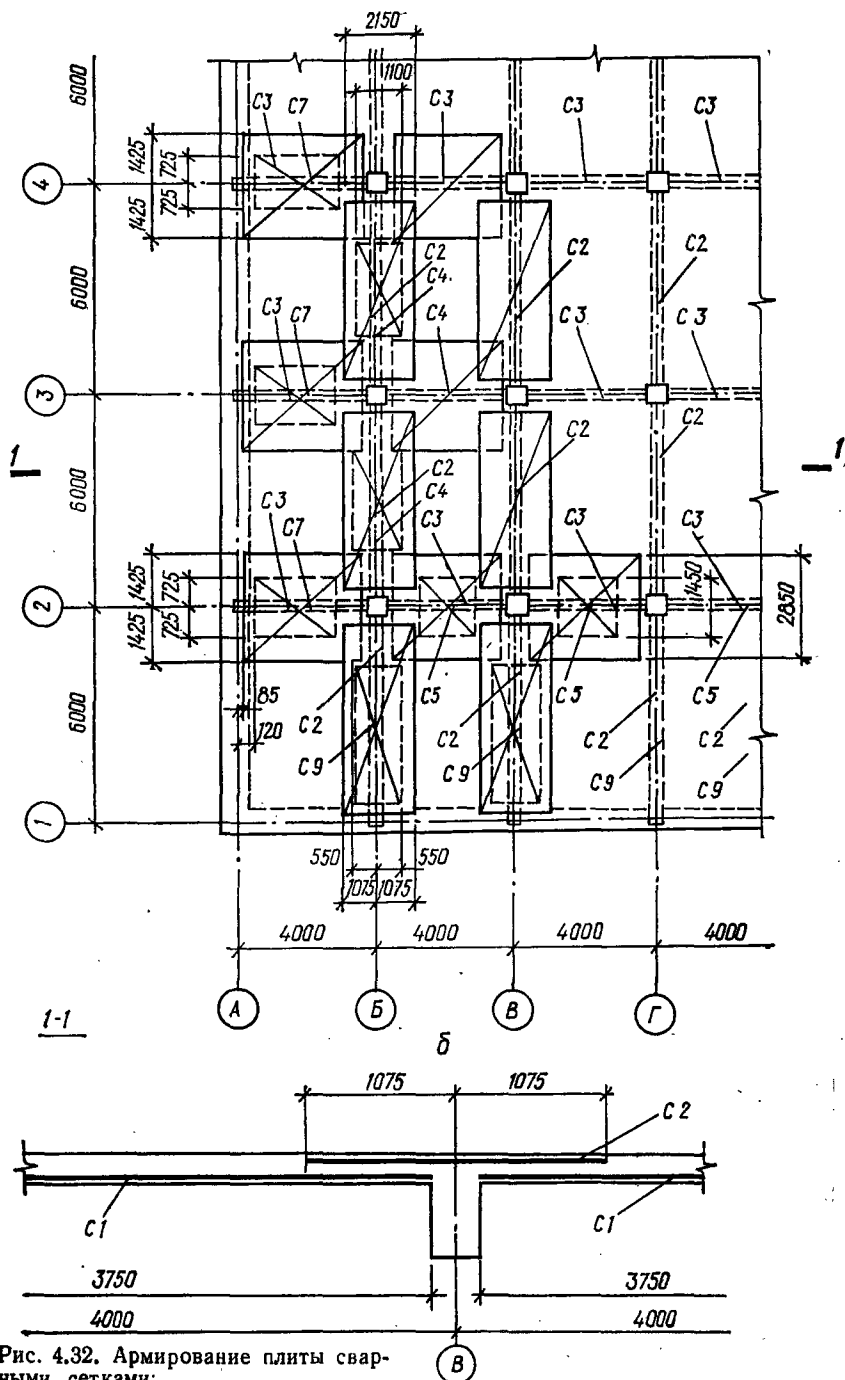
Армирование плиты сварными сетками:
